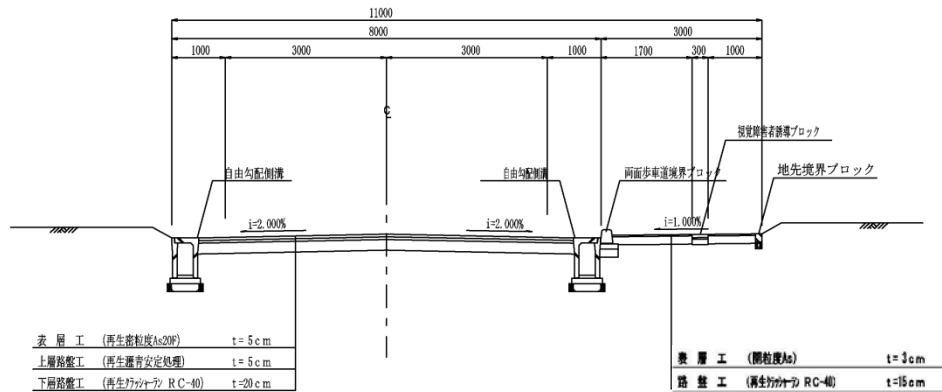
(4) 道路断面図(補助幹線道路:11m 標準断面)
